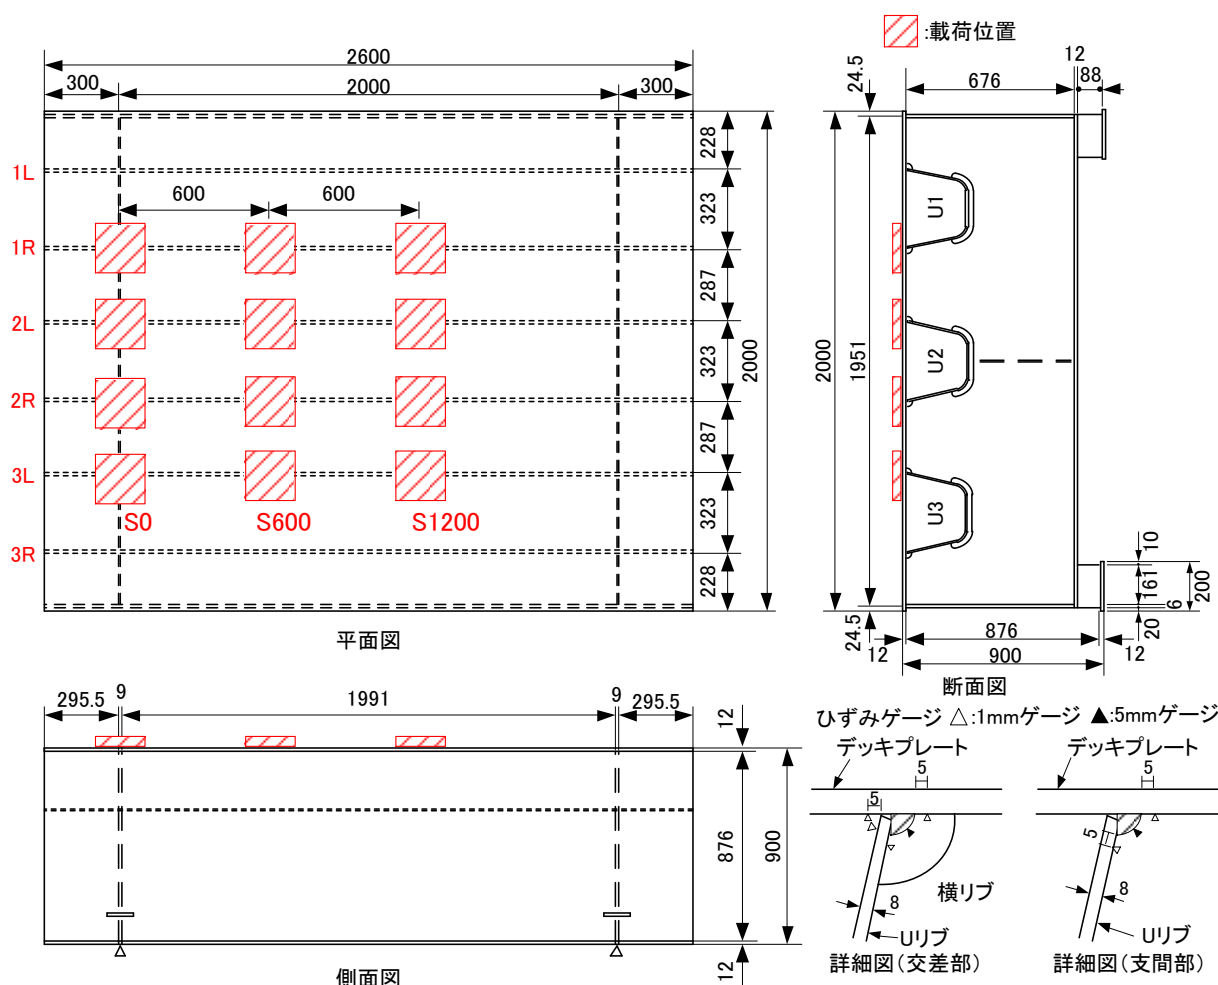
試験体の形状と寸法および荷重位置とひずみゲージ位置
